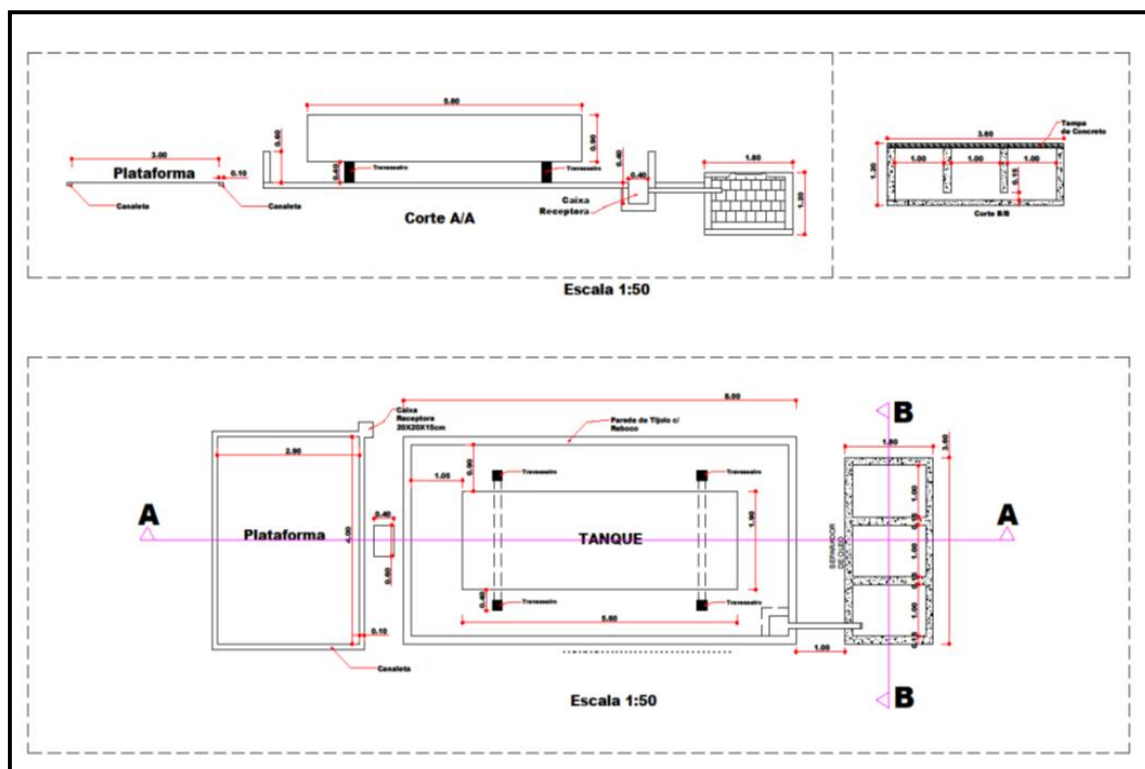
Detalhe do tanque suspenso horizontalmente.
